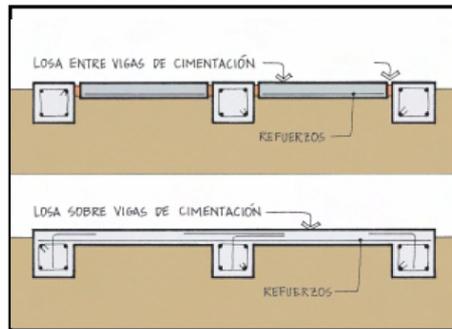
Detalle losa de piso. Fuente AIS
